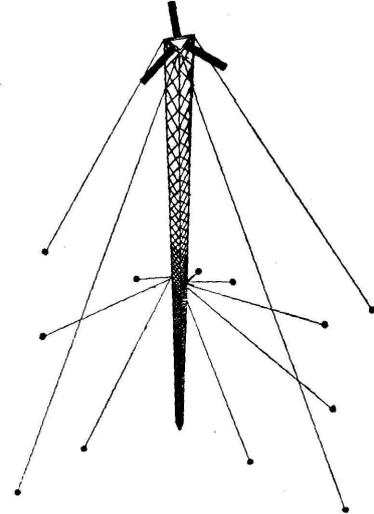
Une idée de la construction du mât d'Allouis, vue d'avion (en haut : les 3 traversiers de 20 mètres de long) ; hauteur : 308 mètres.
